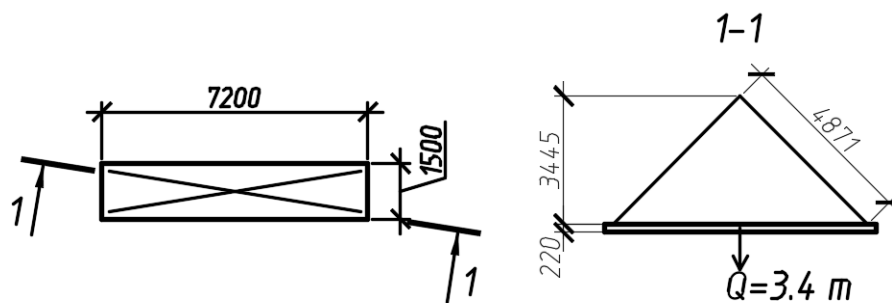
Определение длины стропы для монтажа наиболее тяжелой плиты перекрытия
